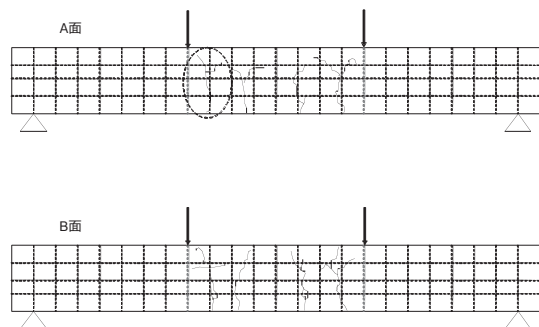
荷重方法とひび割れ発生状況
